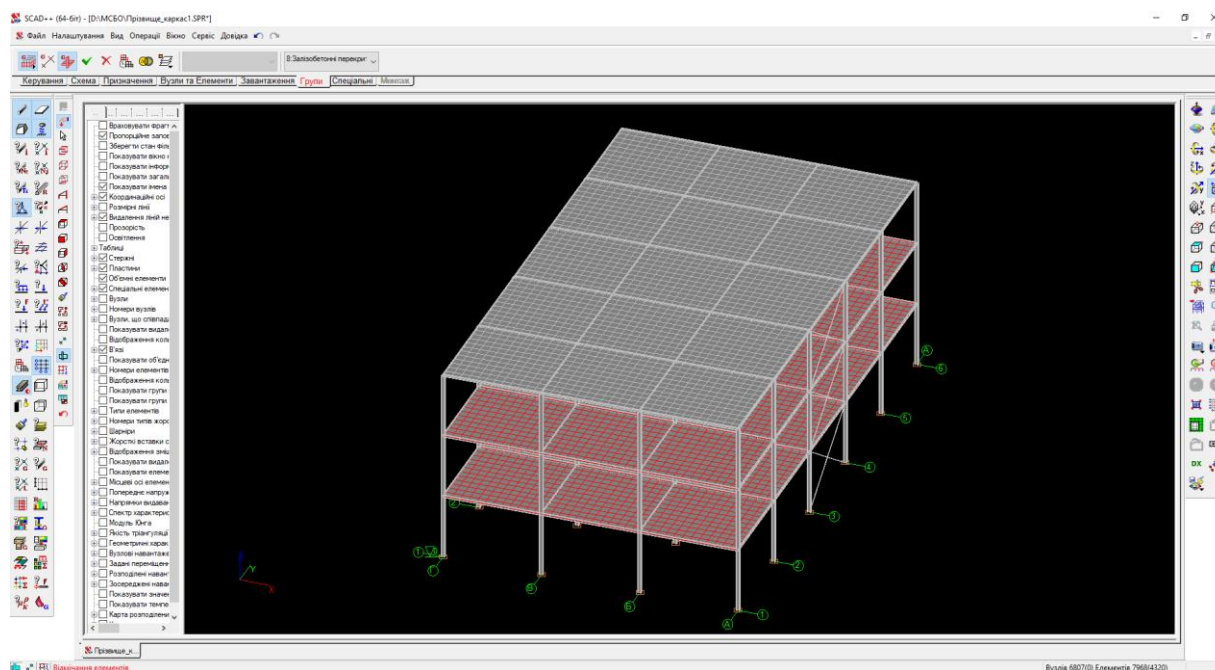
Активована група «Залізобетонні перекриття» на розрахунковій схемі
